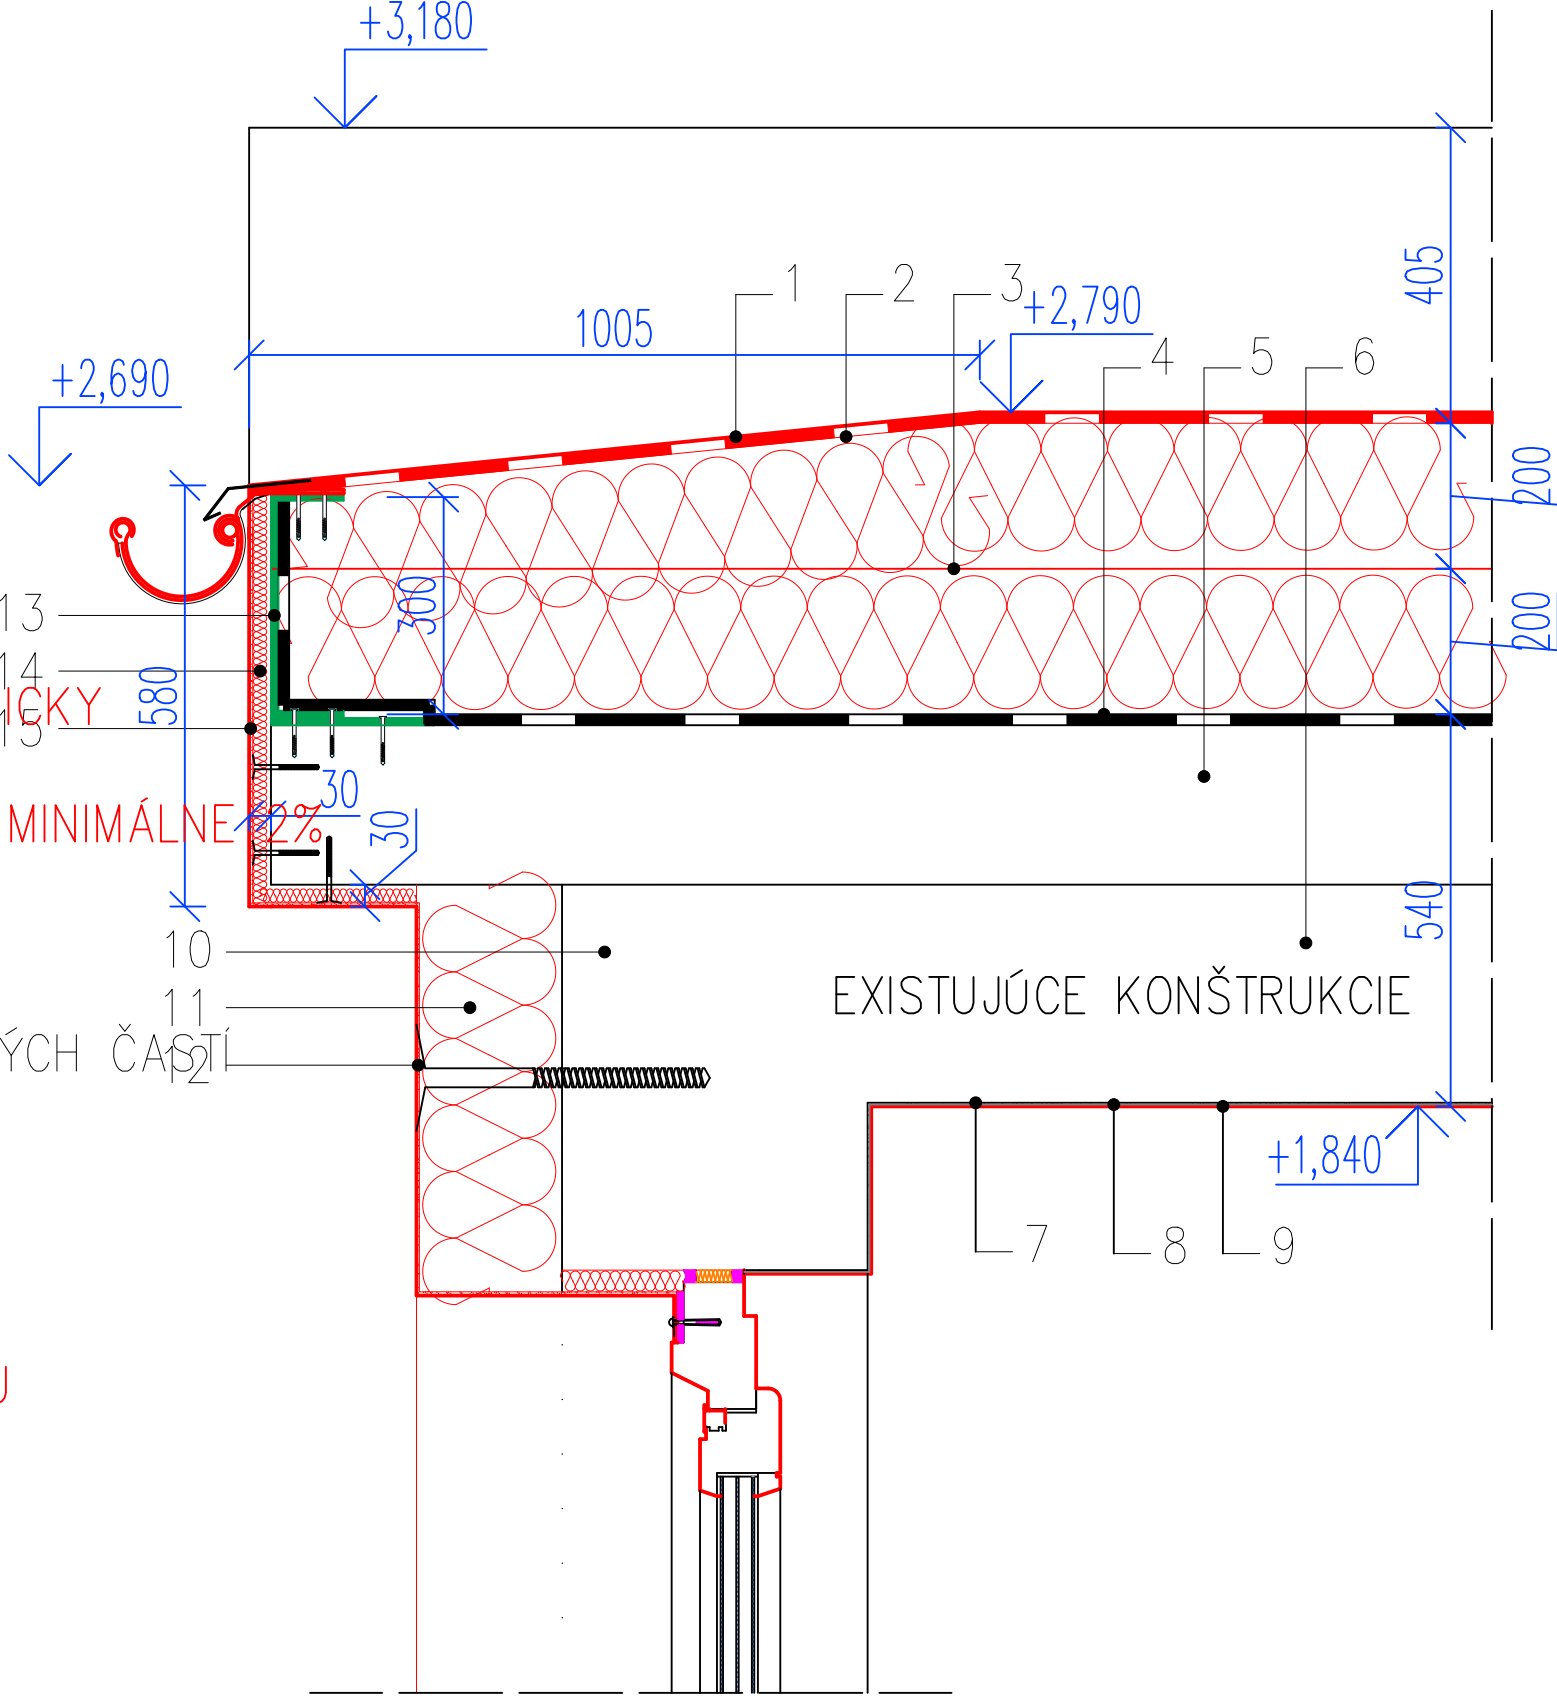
, PLOCHEJ STRECHY, MIERKA 1:10
